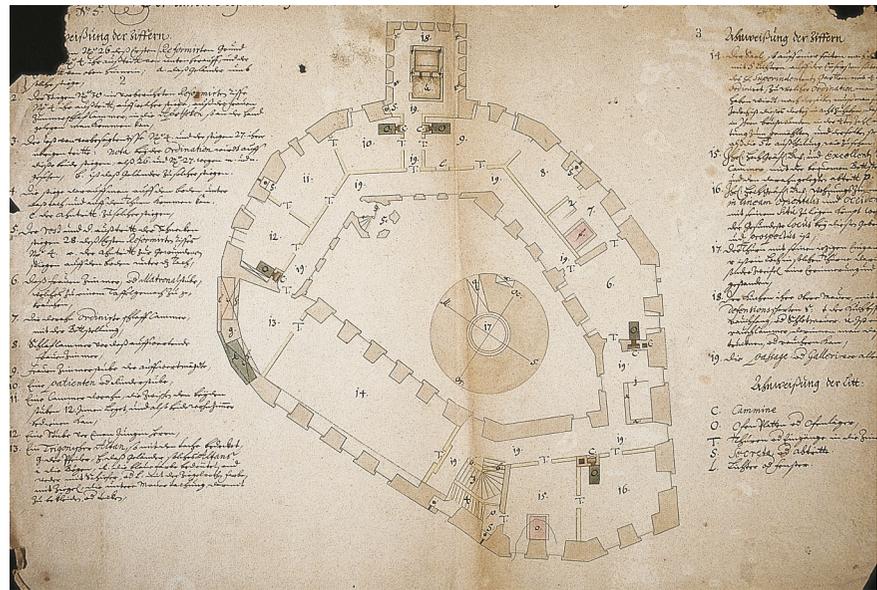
Anderer „reformierter“ Grundriss (Obergeschoss), (undatiert, 1667–1669), HWA Abt. II, Nr. 6317.
